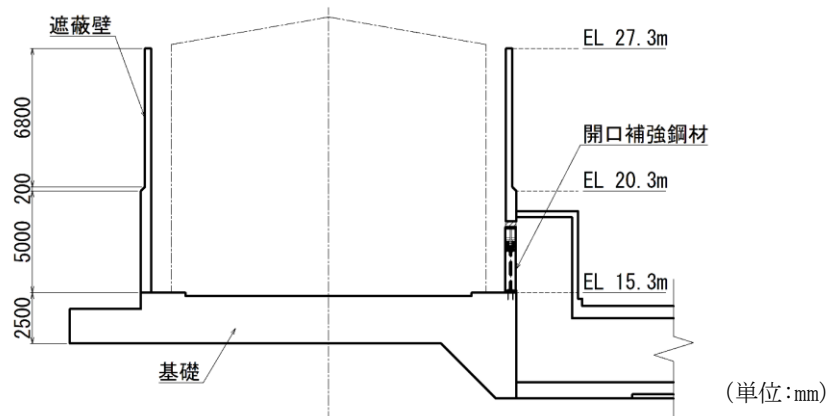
復水貯蔵タンク遮蔽壁 断面図 (A-A断面)
